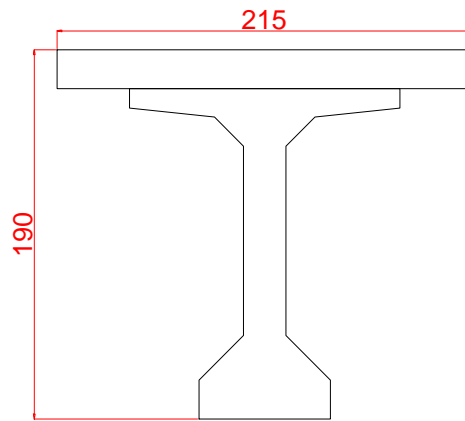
Coupe transversale (poutre + hourdis) à mi travée.
